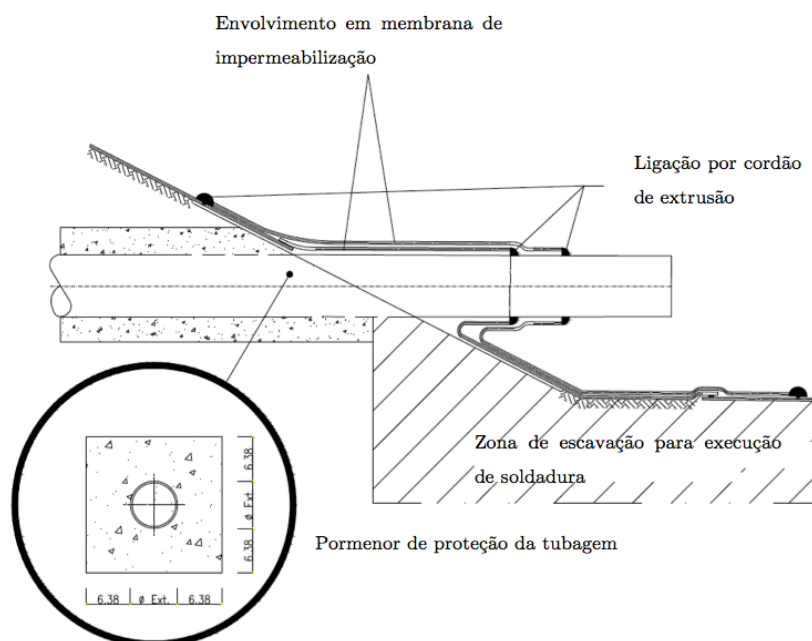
Pormenor de soldadura na intersecção da tubagem com sistema de impermeabilização, zona de septos de separação de alvéolos.
